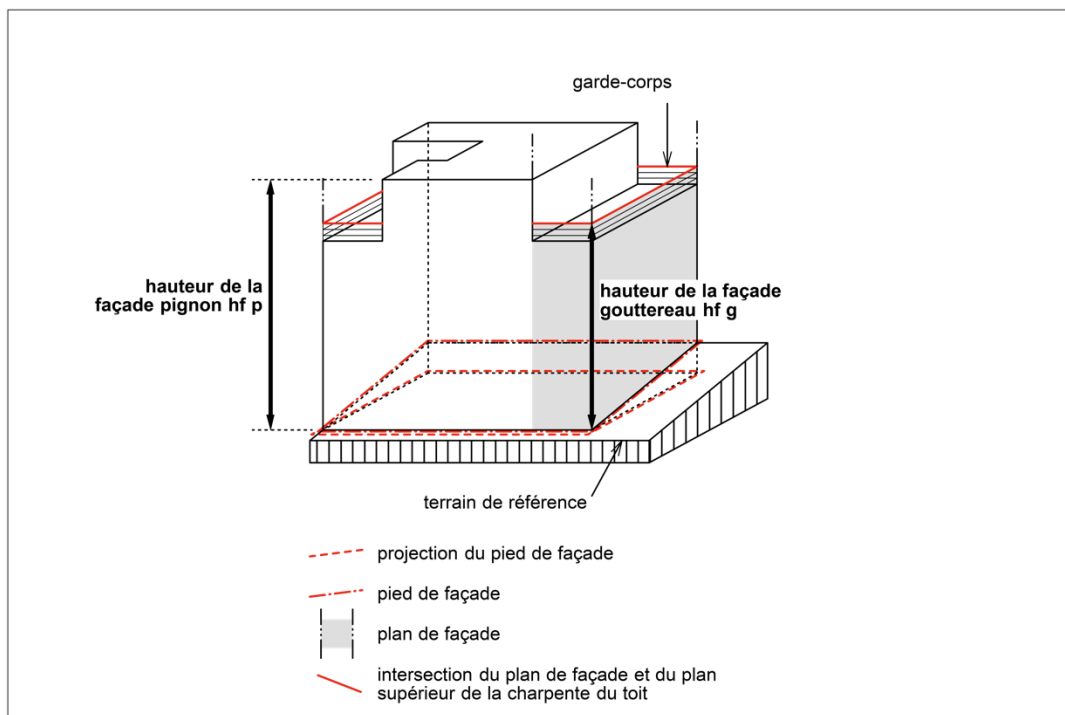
mesure des hauteurs de façades gouttereau et pignon (à l'exception du quartier de la Gare)
